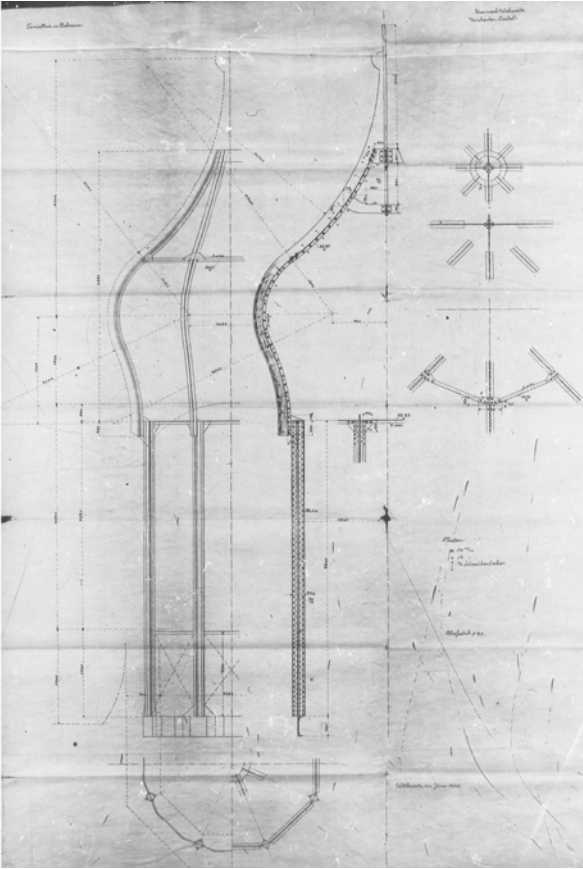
Stahlkonstruktion Kuppel Detail 02
